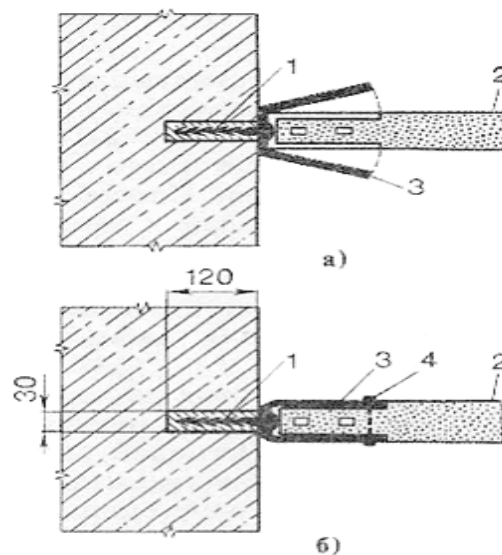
Кріплення панельних перегородок до стін вилючний скобою:
